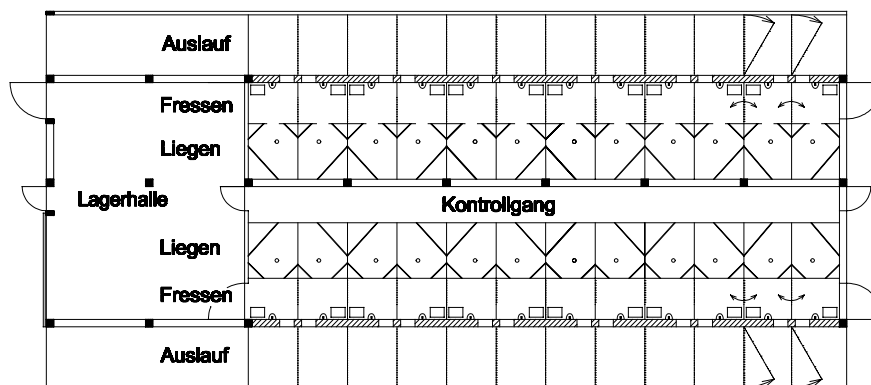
Grundriss Abferkelstall, Beispielsbetrieb
